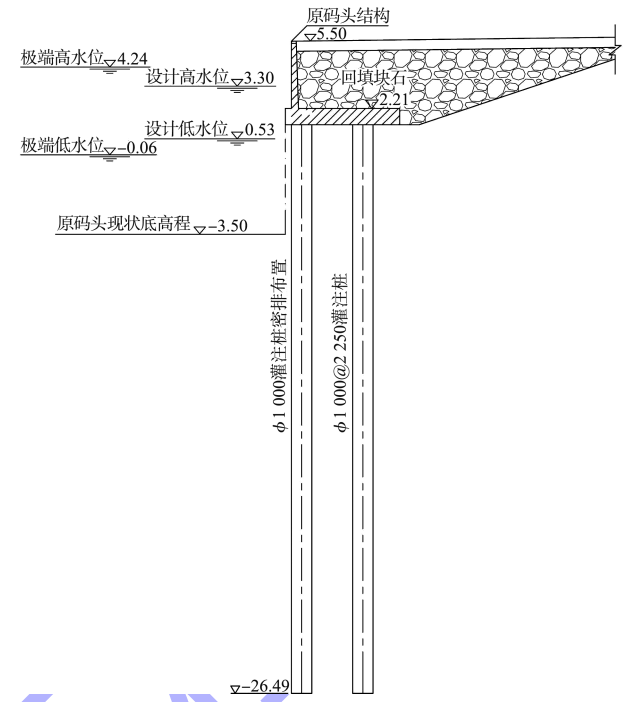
原码头结构断面 (高程: m; 尺寸: mm)
